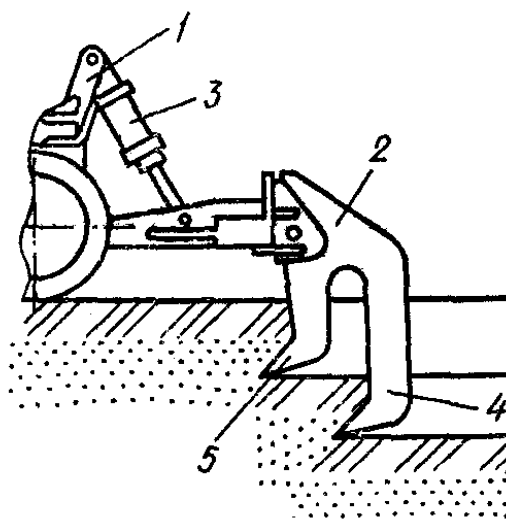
Схема двузубого рыхлителя: 1 – подвеска рыхлителя;
